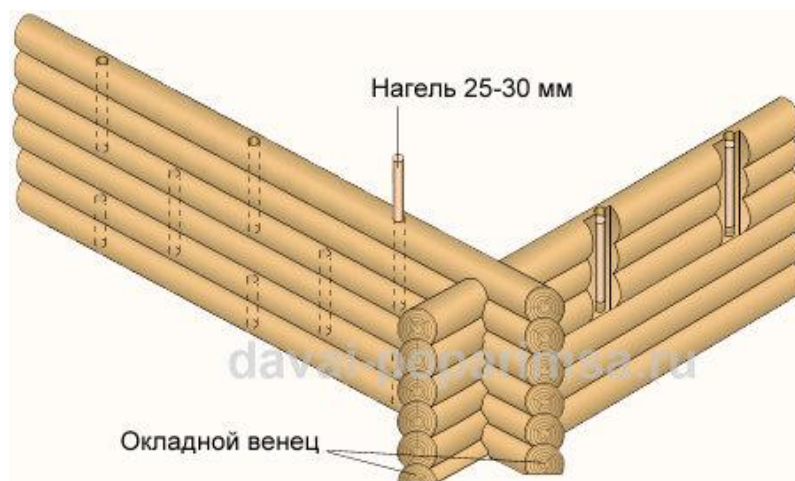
Крепление бревенчатых стен нагелями
